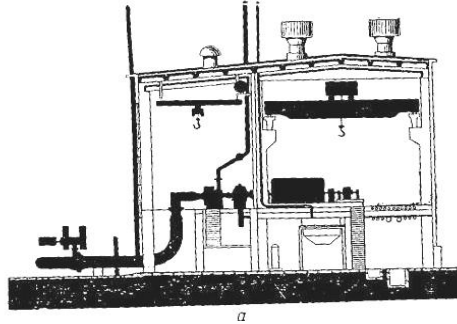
Установка газоперекачивающего агрегата (СТД-4000-2) в компрессорном цехе, на отметке + 4,8 м
